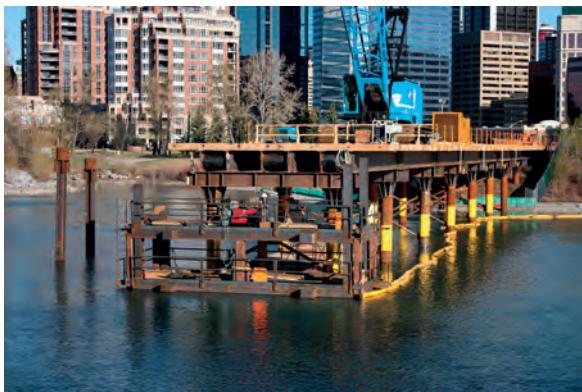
Cantiere: fase di montaggio struttura temporanea
